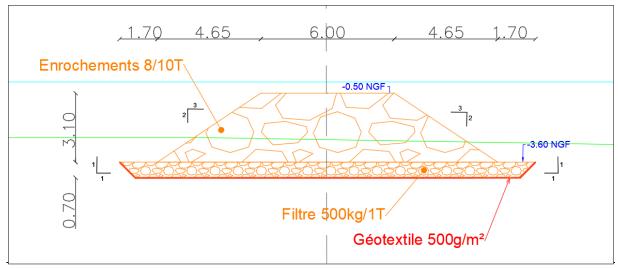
Coupe type selon B-B' du brise lame en enrochement sur la plage du Centre-Ville
